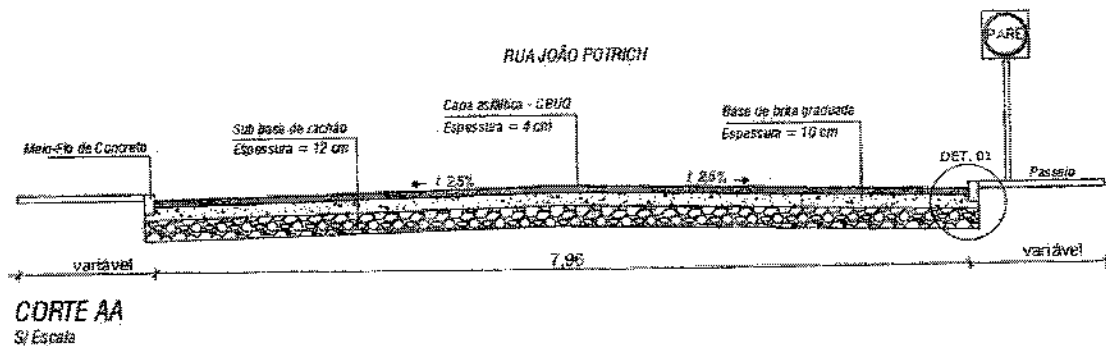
Detalhe pavimentação asfáltica Rua João Potrich.
